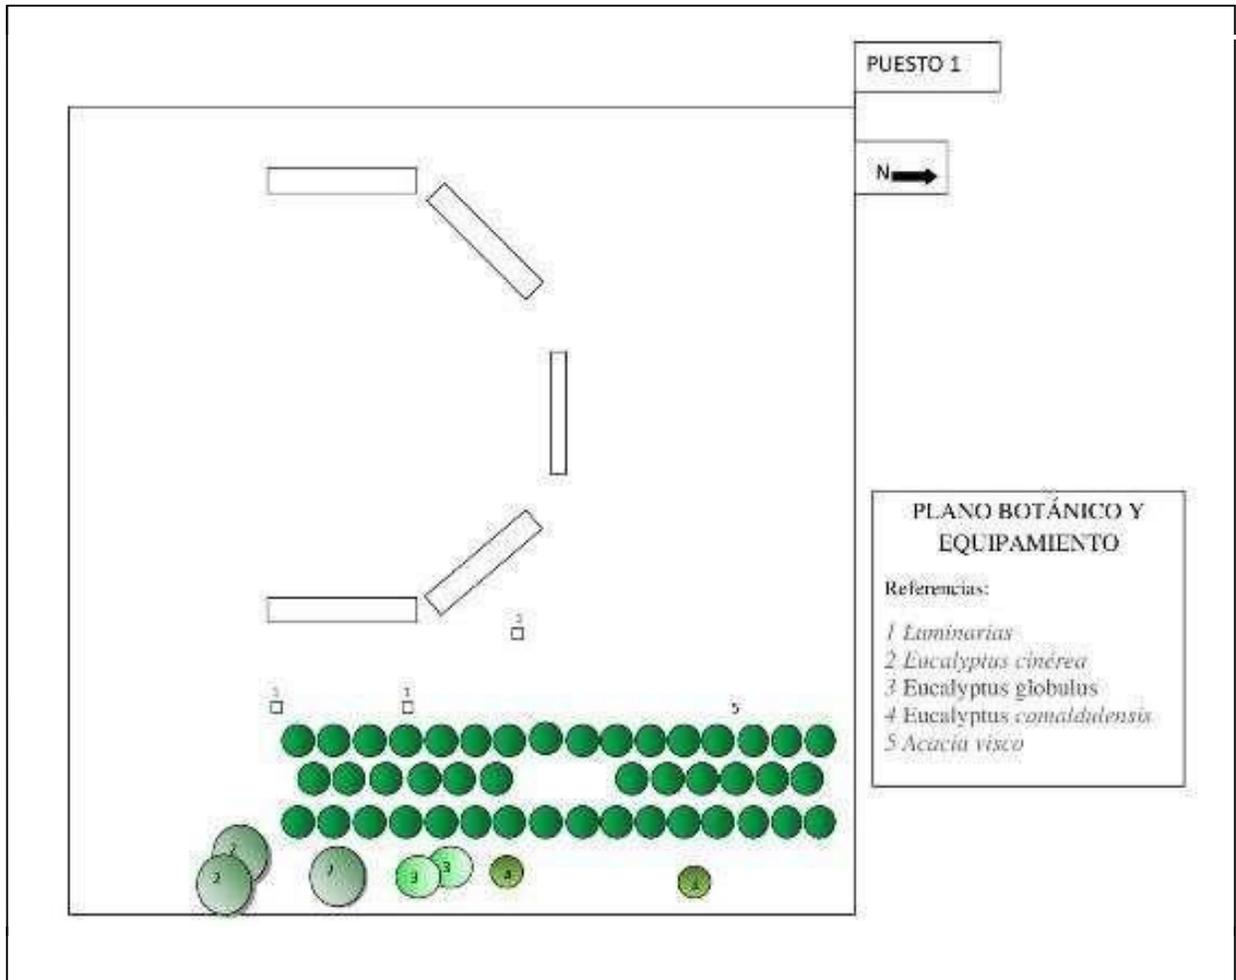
Plano de distribución de árboles preexistentes y a implantar.
